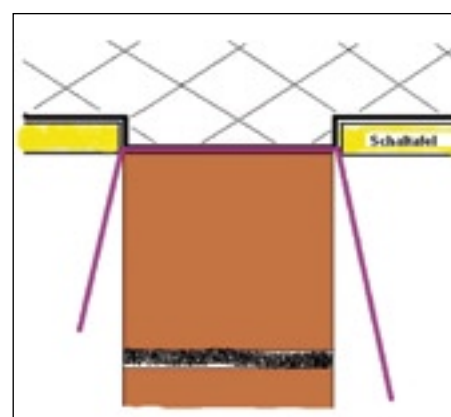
Der Maurer hat eine PE-Folie als Witterungsschutz eingesetzt. Er benutzt die Deckenschalung zugleich als seitliche Abschalung, um die Höhendifferenz der Mauerkrone bis unterkant Betondecke statt mit einem Mörtelglattstrich direkt mit dem Deckenbeton zu füllen. Die Lage der Folie gibt wieder die Soll-Bruchstelle vor.
